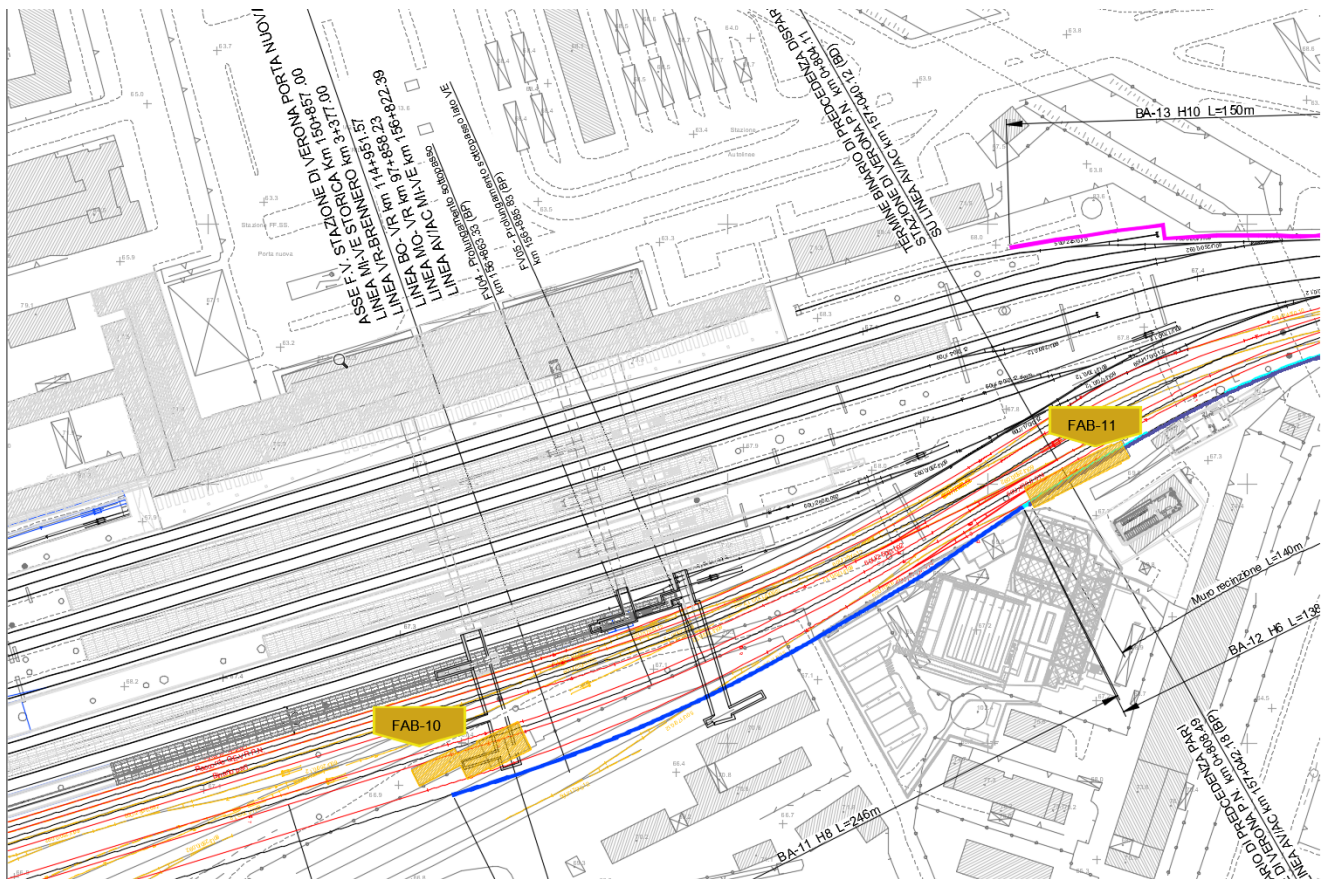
Stralcio planimetrico zona Verona Porta Nuova
